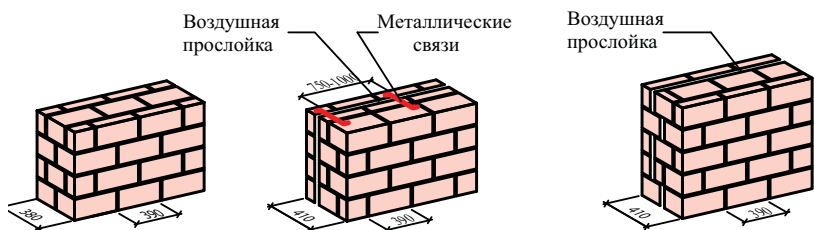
Кладка из бетонных камней (блоков) [4], 1951 г.
